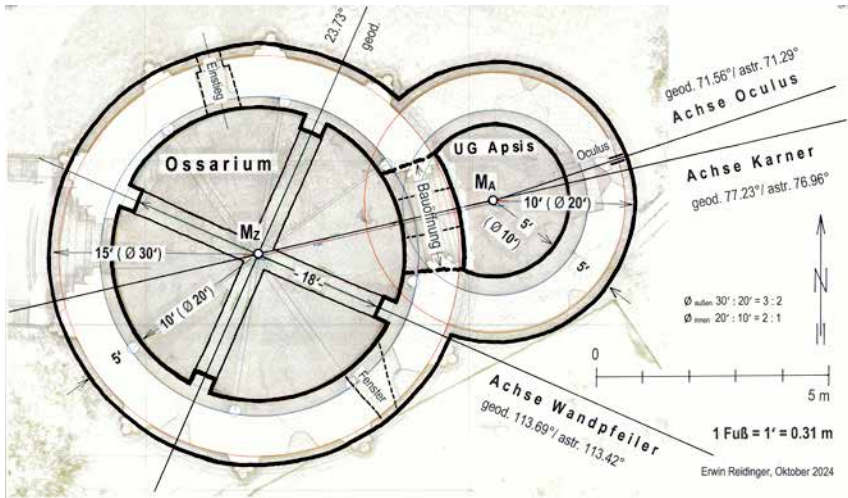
und 14b: Karner Hartberg, Grundriss Unterbau (Schnittebene vgl. Abb. 3)
